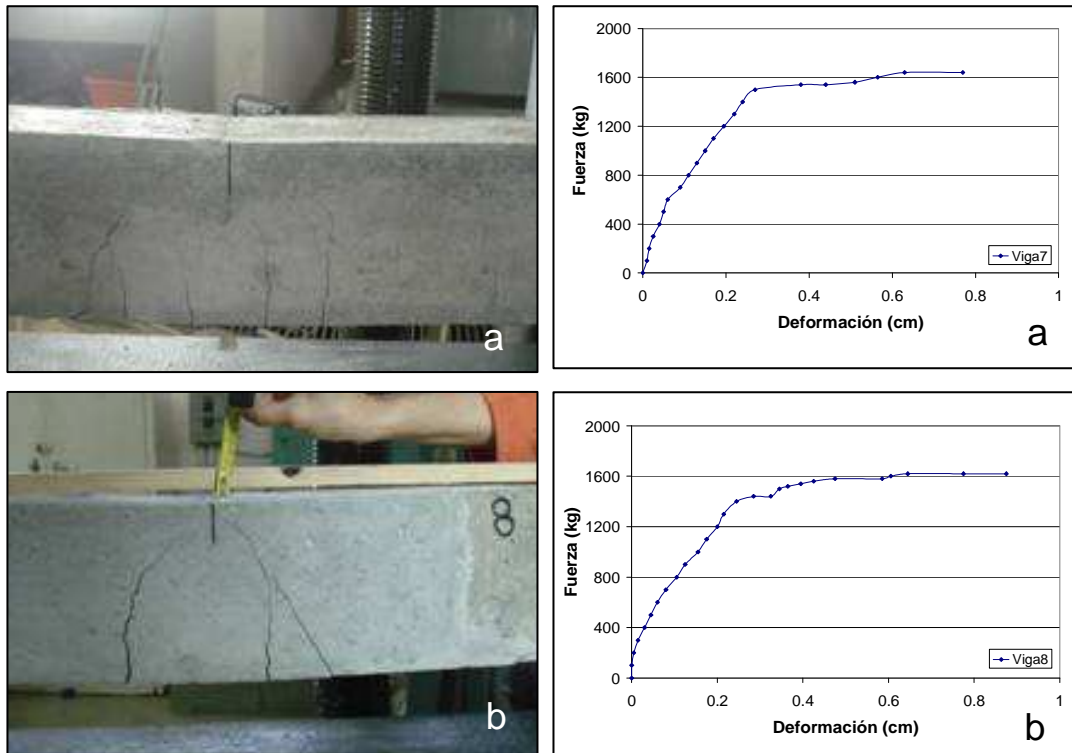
Vigas reparadas con morteros. Ensayo a los 5 meses de la reparación.
